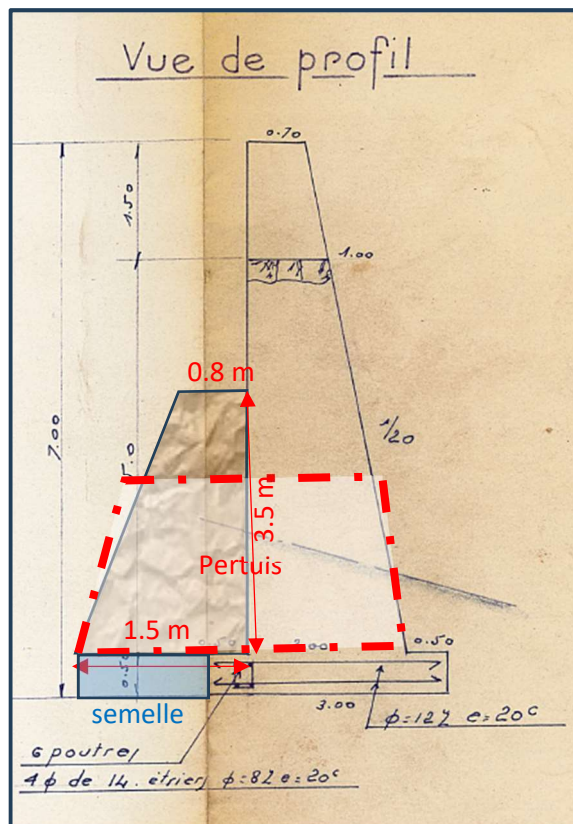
Coupe de l'ouvrage amont et figuration du renfort en enrochement
